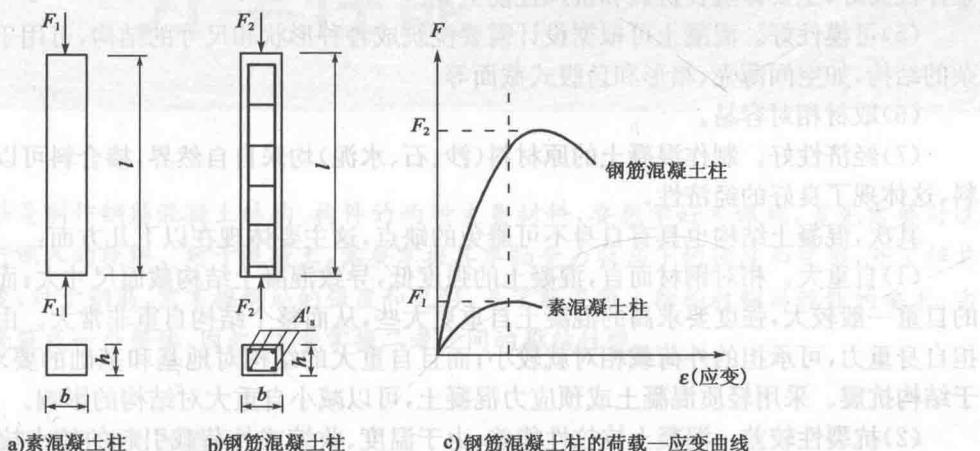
素混凝土和钢筋混凝土轴心受压构件的受力性能比较
